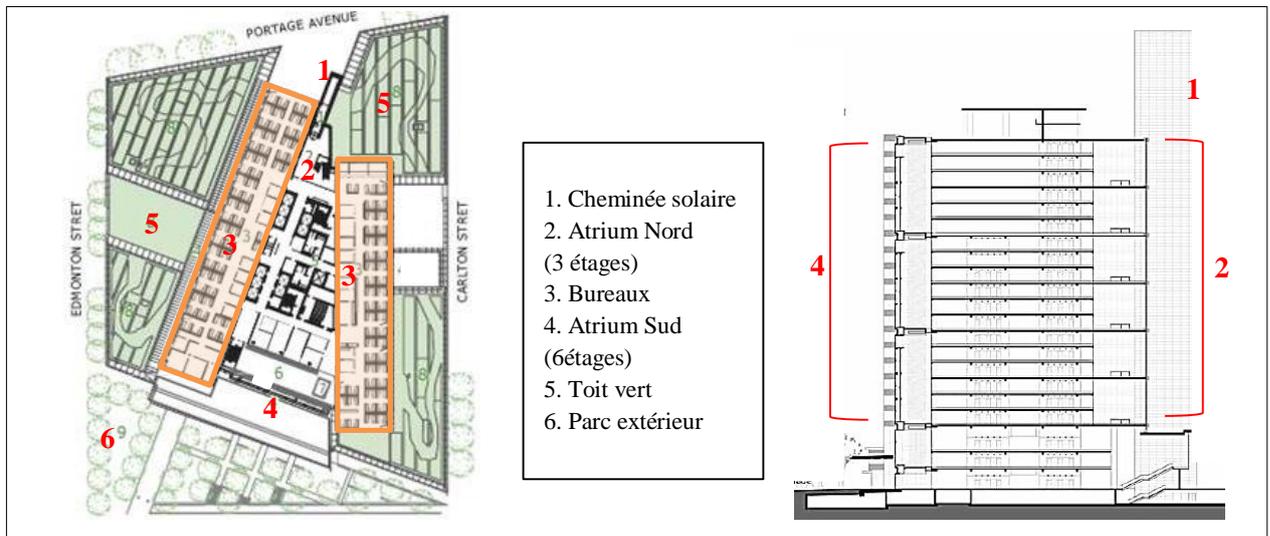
Vue en plan des tours et la coupe passe par les atriums Nord et Sud.
